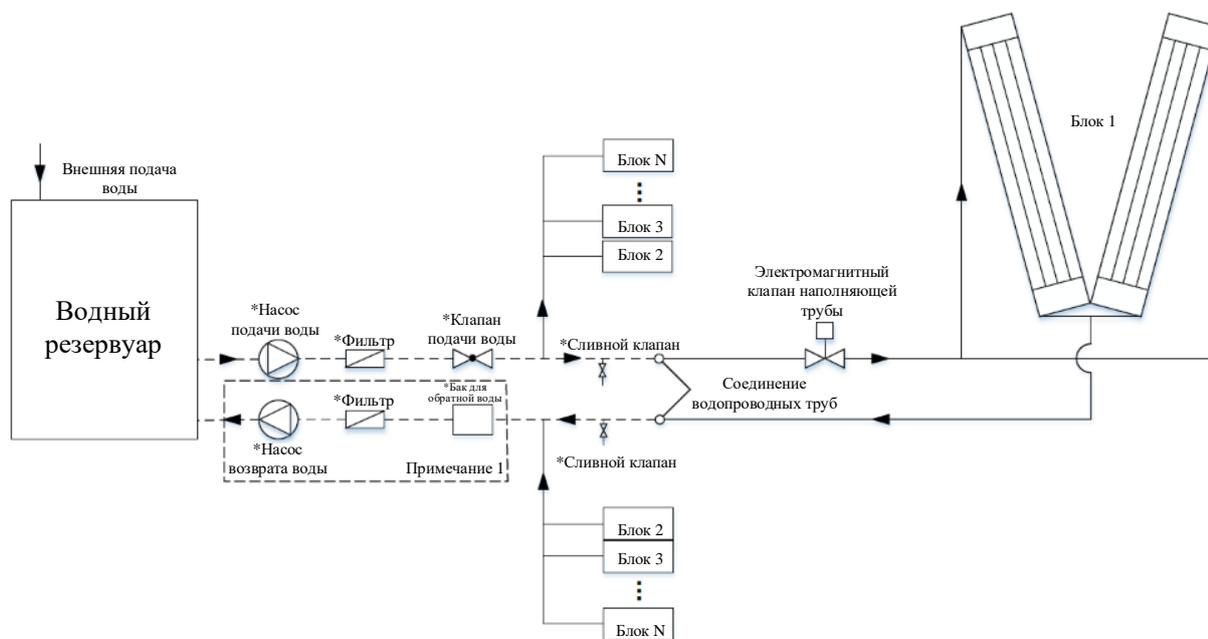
Схема соединения труб системы испарительного охлаждения с мокрой пленкой (один к нескольким)
